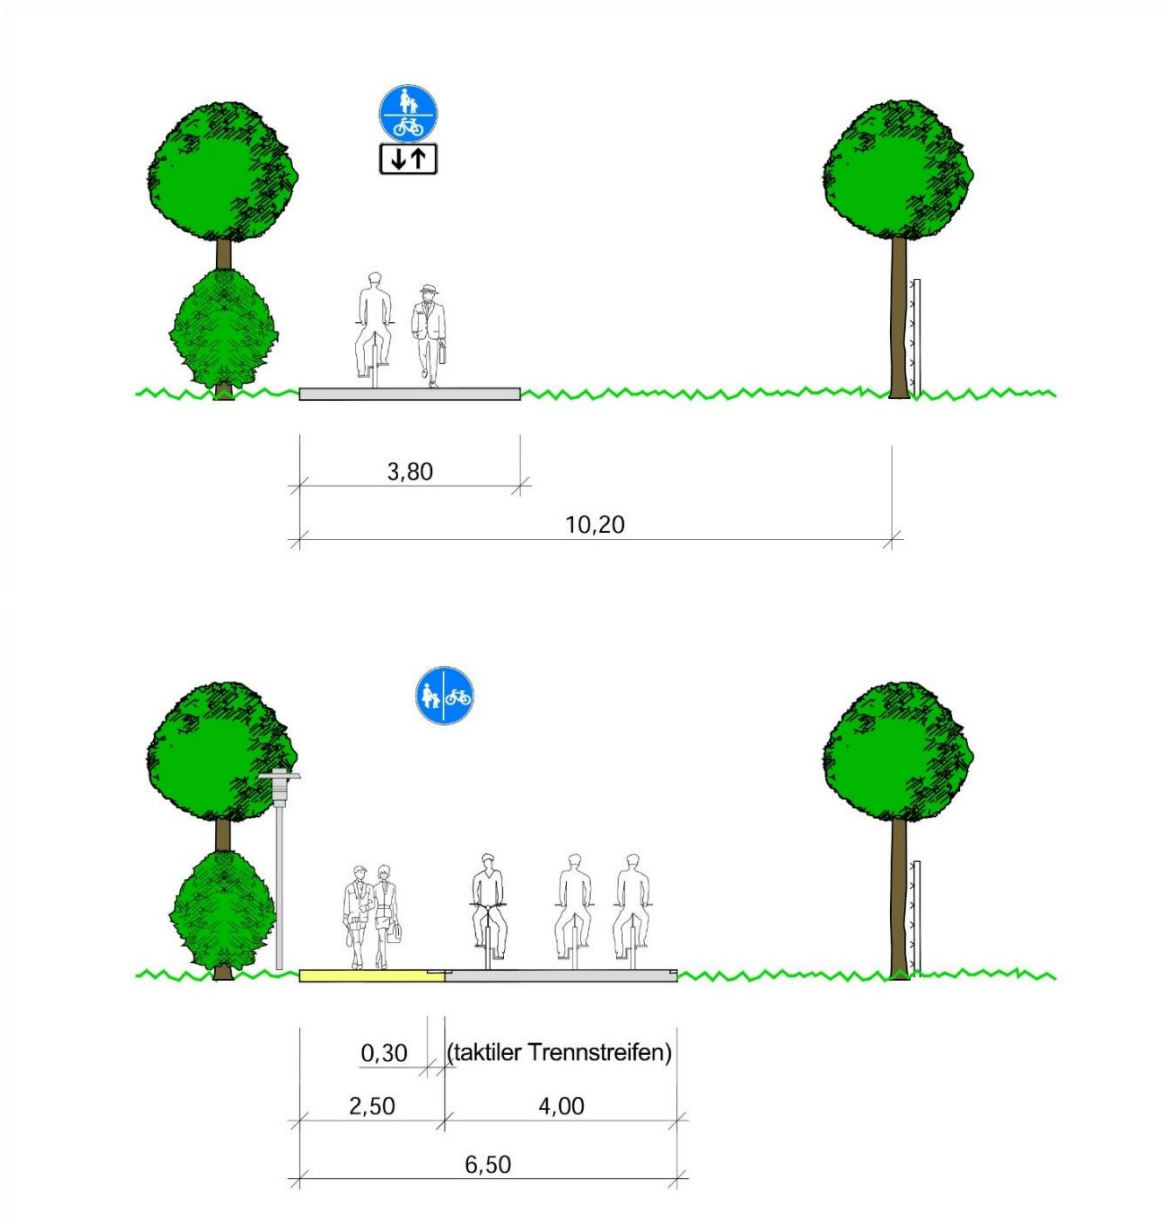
Gem. Fuß-/Radweg (Ingolstädter Landstraße bis Gerlachstraße) – Bestand (oben) und Planung (unten)
